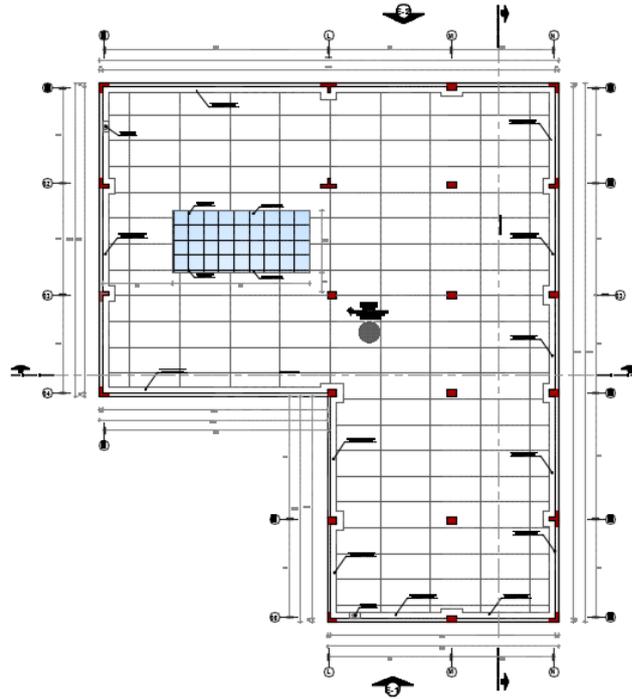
Plano de techos - Bloque A – Zona de rehabilitación.
